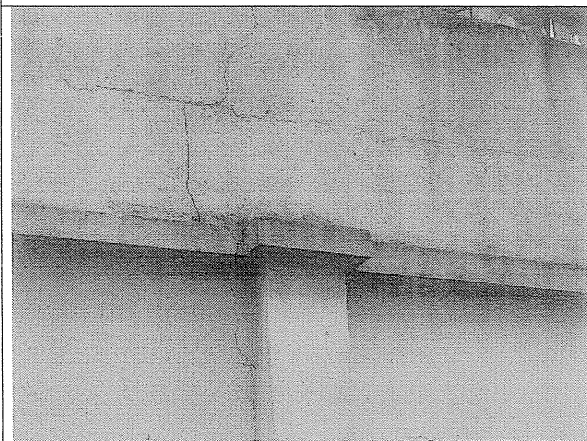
Fisuras y deterioro en muro de lindero del costado sur.
